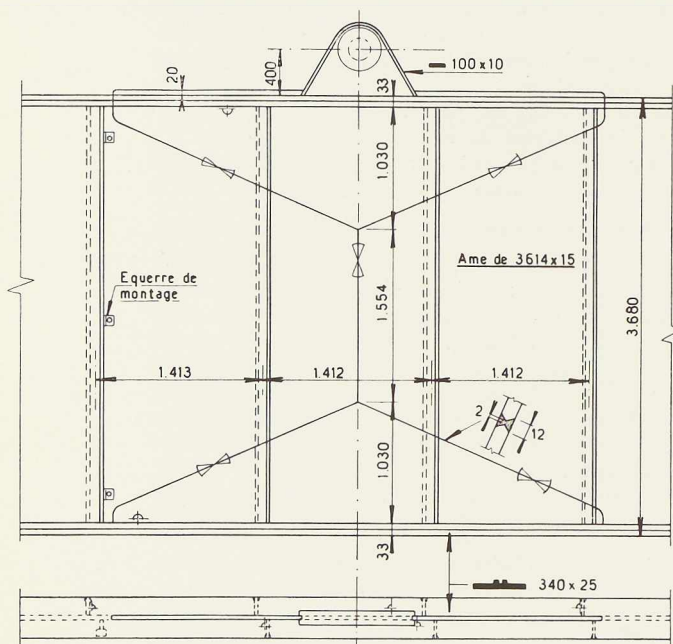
Détail du joint d'assemblage de la poutre à âme pleine mobile, au droit de l'axe de rotation.
